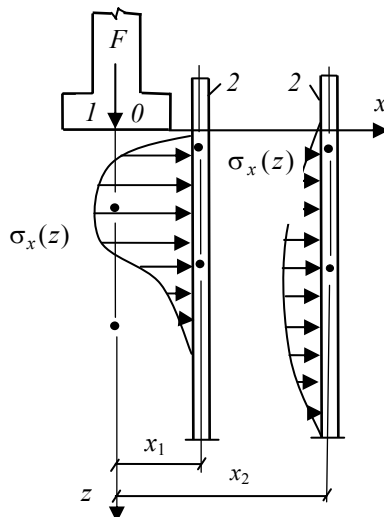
Эпюры бокового давления грунта на ограждающую стенку (2), вызванного нагрузкой на фундамент (1)
